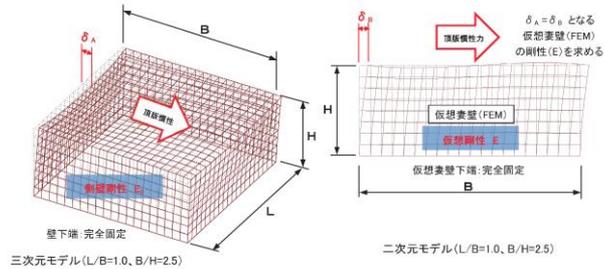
三次元効果の解析モデル (配水池イメージ)
